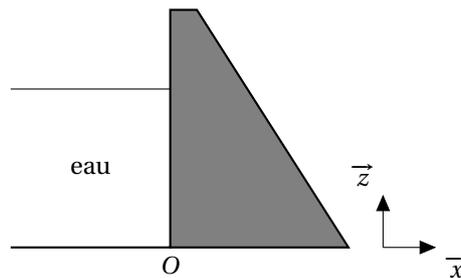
Section du barrage de Guerlédan. Le point O est situé sur le plan central du barrage. La coordonnée y des points du barrage est donc comprise entre $-L/2$ et $L/2$.
